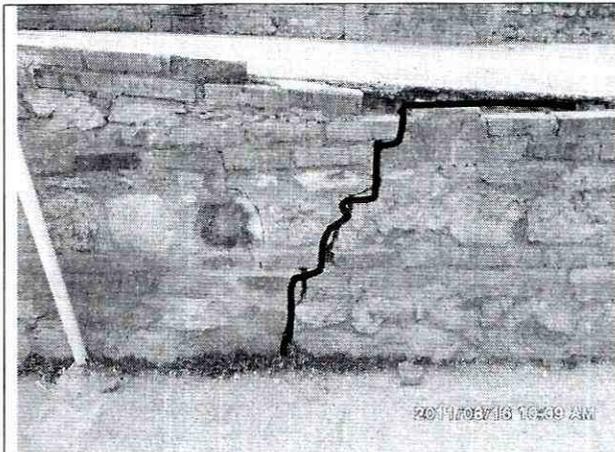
Múltiples grietas en muro de cortención de talud ubicado en el patio del colegio.
